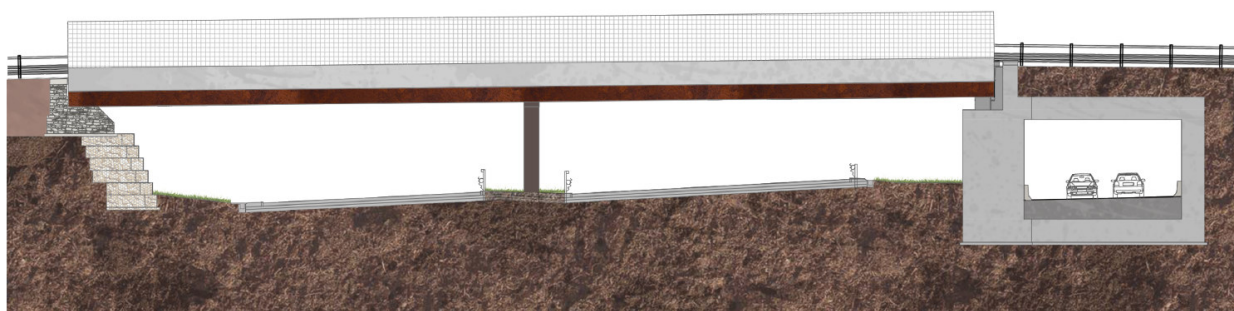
Profilo longitudinale del Cavalcavia 06 – Lotto 4
